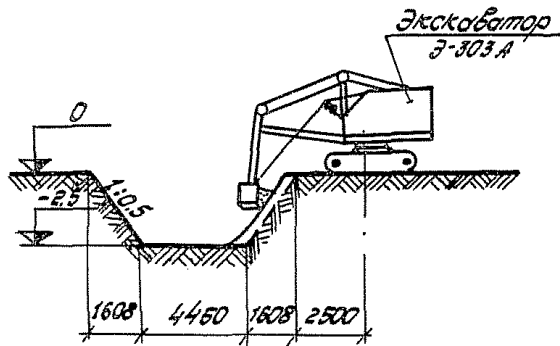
Разрез 1-1 на стадии разработки котлованов.
